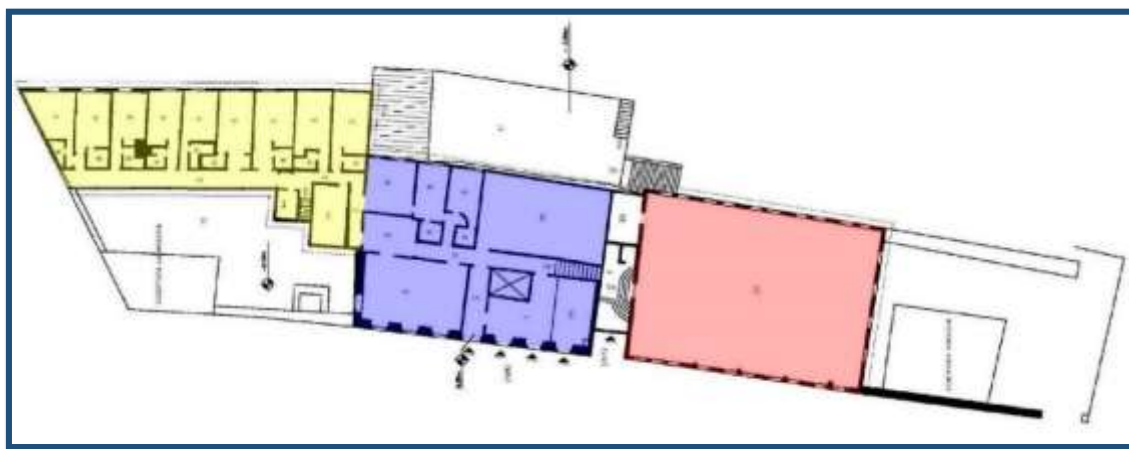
Planta do pavimento térreo com esquema da Divisão dos blocos construtivos. Em azul, o edifício denominado azulejado. Em amarelo, o denominado edifício anexo, e, em vermelho, o denominado edifício marrom.
